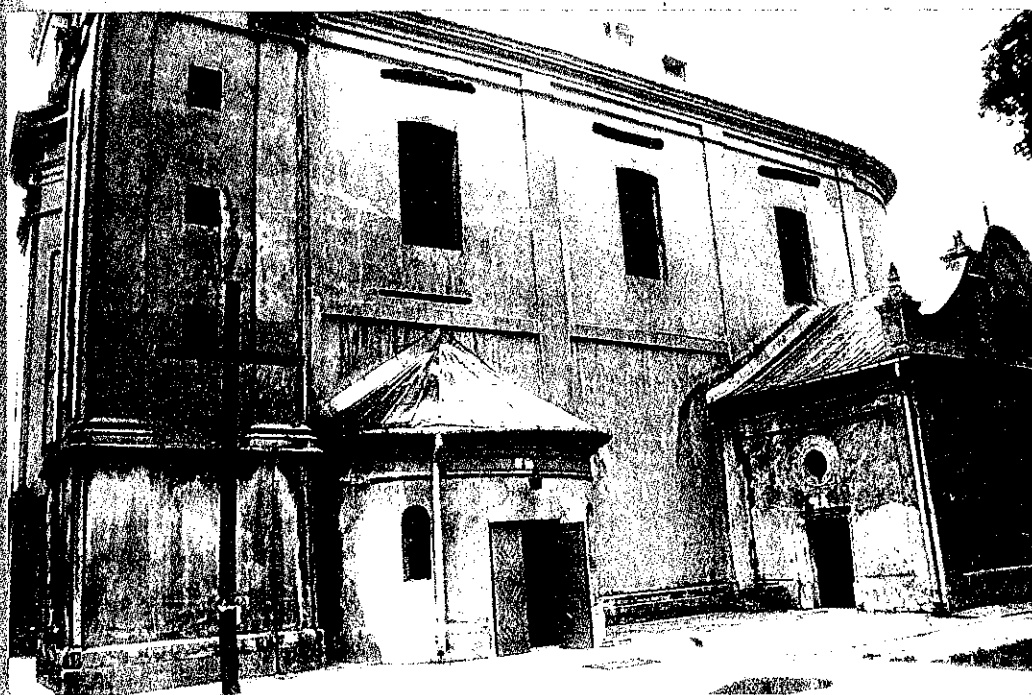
Widok południowo-zachodniej elewacji Kościoła
